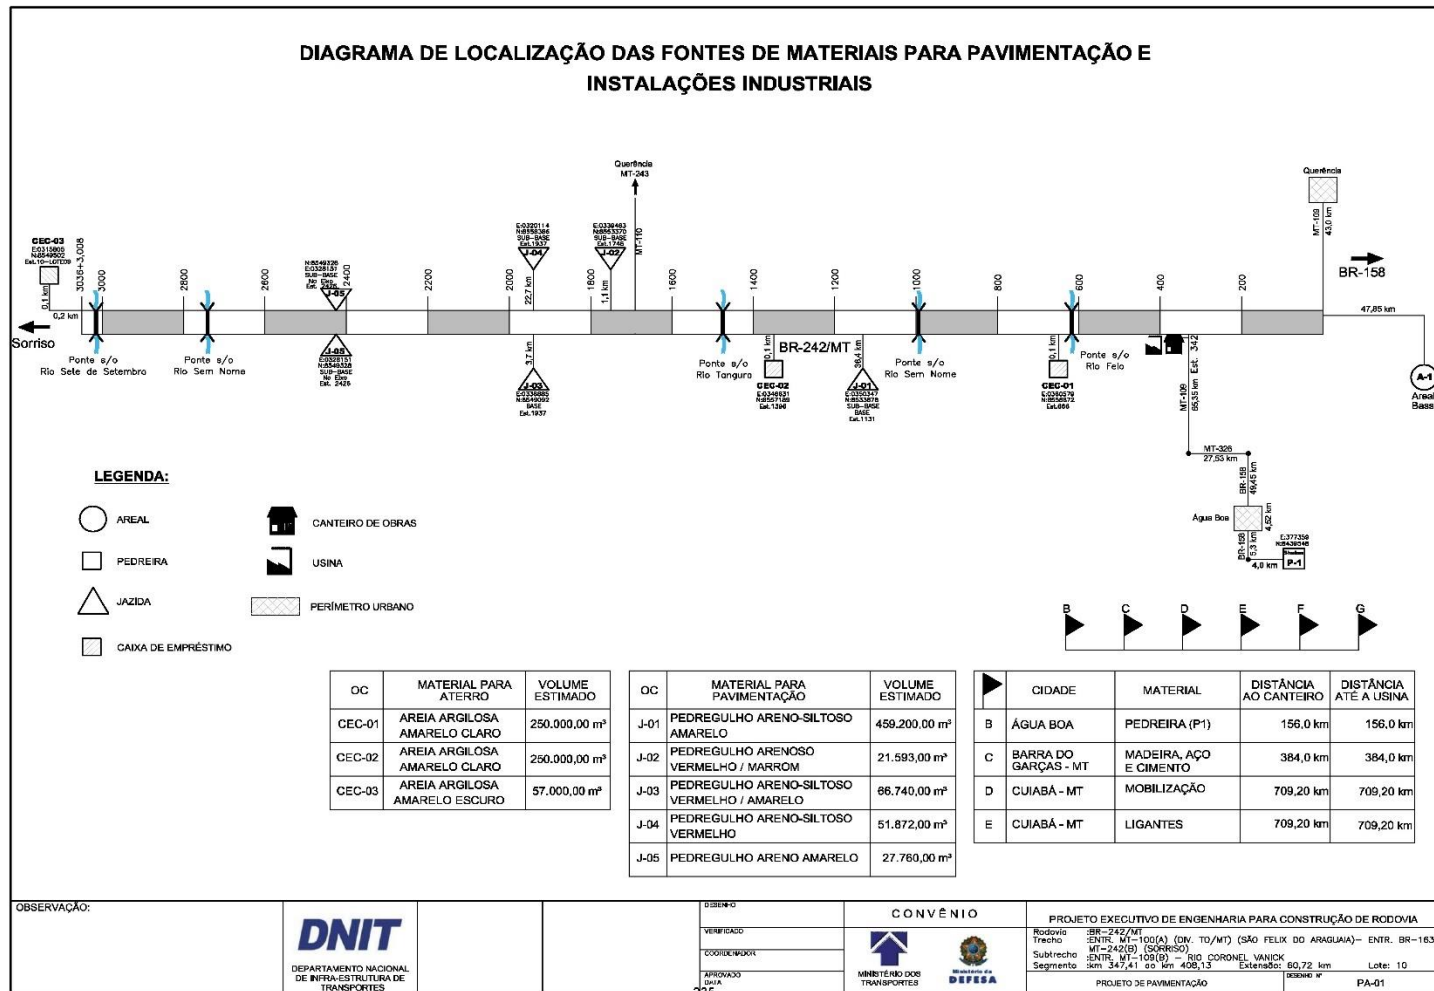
Diagrama da localização das fontes de materiais para a pavimentação e as instalações industriais (Segmento C – lote 10).
